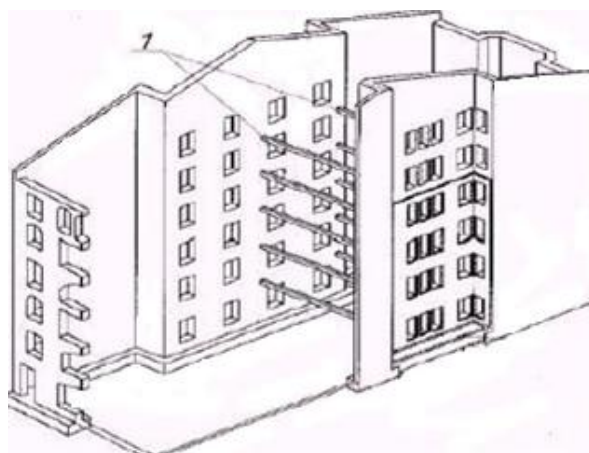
Esquema do reforço dos pavimentos em madeira com vigas metálicas [Cóias, 2007]
